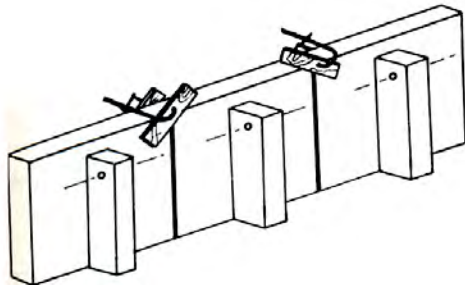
Placas de concreto precolado con atiesadotes (también pueden utilizarse piezas de block macizo o de block hueco)
